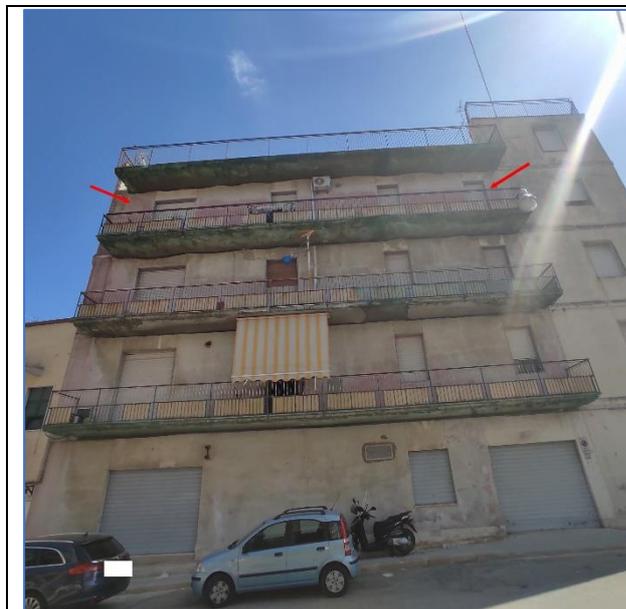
VEDUTA ESTERNA LATO N-O
